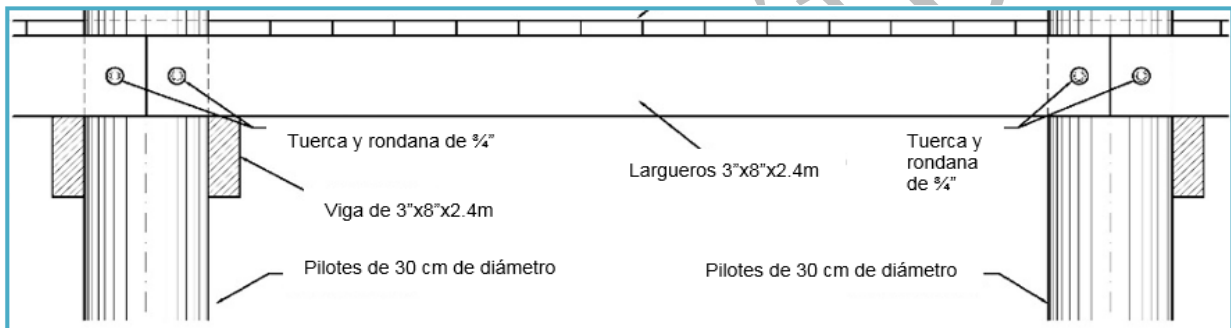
Detalle longitudinal de la estructura de conexión.
